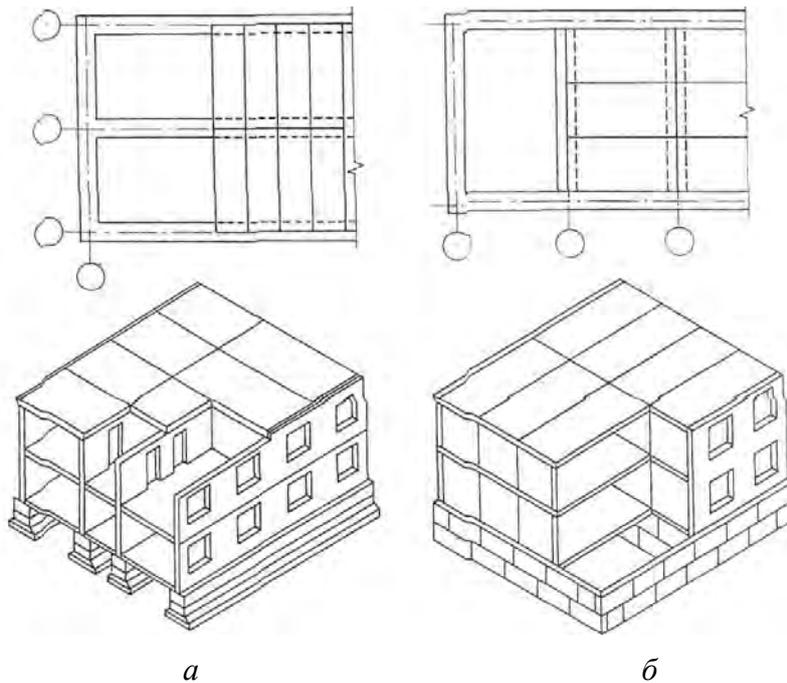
Здания с несущими стенами: *а* — продольными; *б* — поперечными
